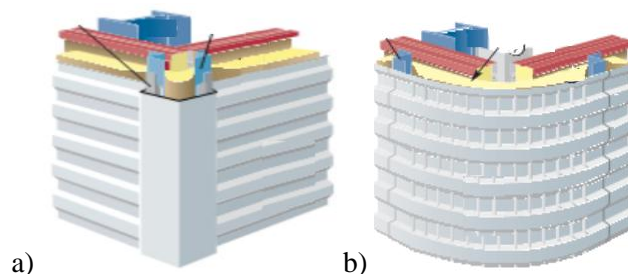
Remate de esquina vertical da solução Globalwall DS: a) Perfil de canto, b) Perfil curvo [91].
